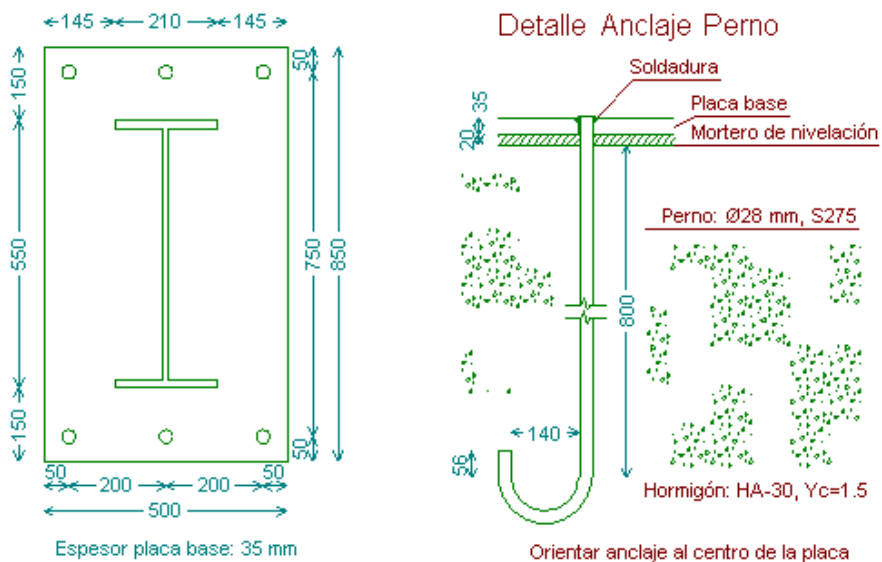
Planta de la placa y detalle de anclaje del perno.
